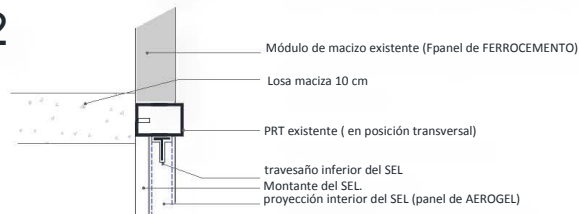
Corte por fachada del Sistema Envolvente propuesto.
